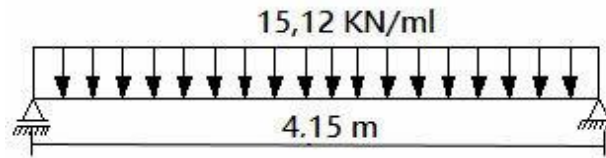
1: Schéma statique de la poutre de chaînage à l'E.L.U
